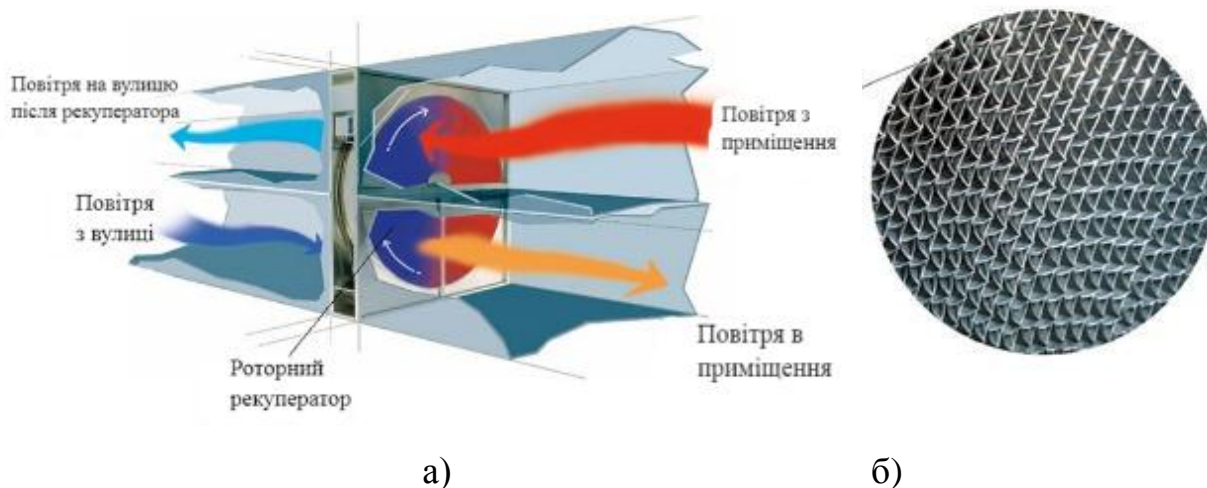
Схеми роторного рекуператора: а – принцип роботи; б – конструкція
